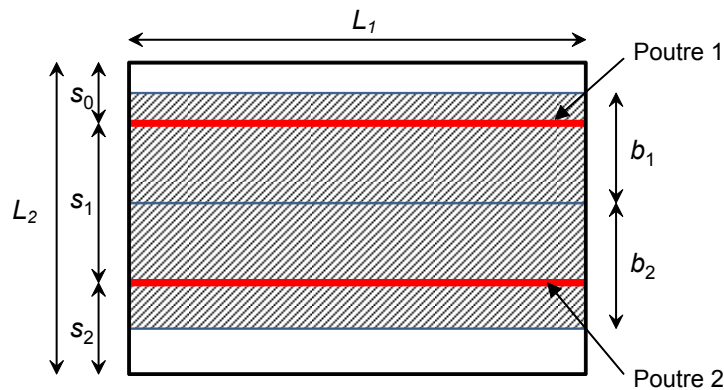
Disposition générale d'un plancher mixte ($n_{ub} = 2$)
